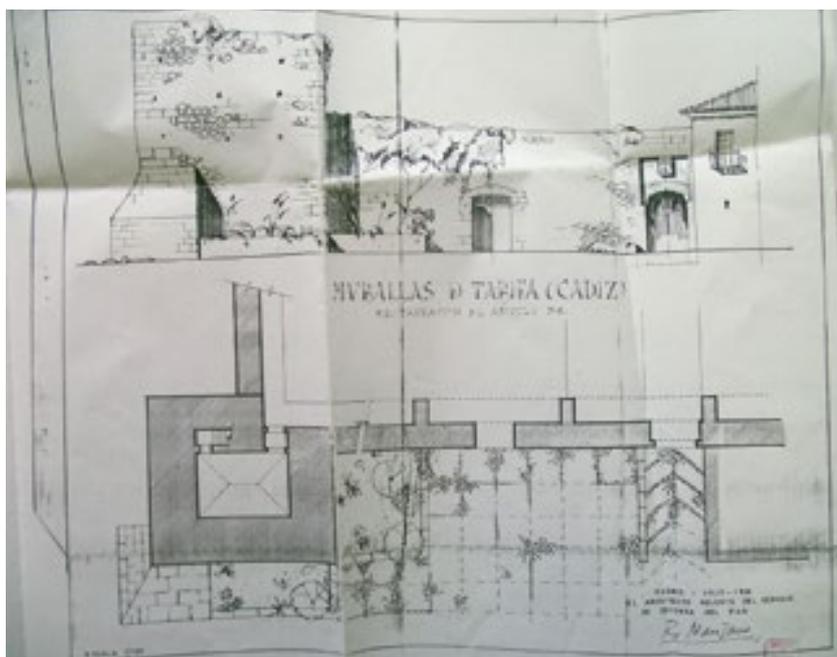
Plano y alzado de un proyecto de restauración de las murallas. Año 1964
